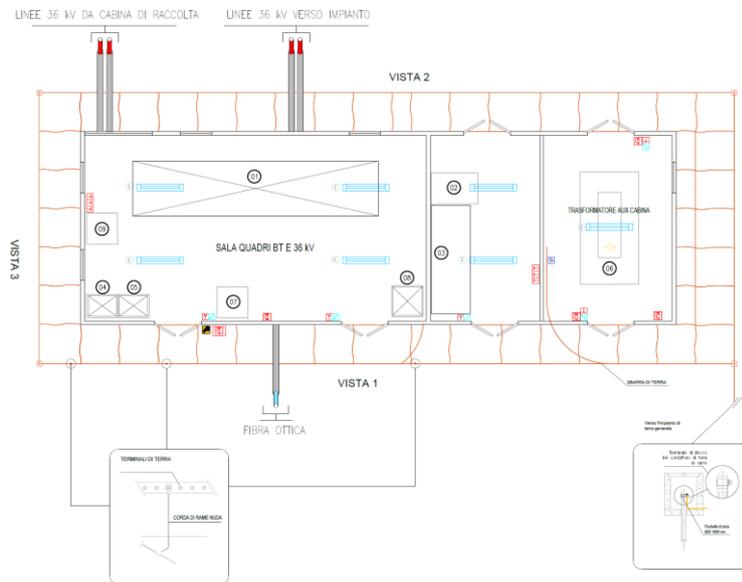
ALLESTIMENTO TIPO CABINA DI SEZIONAMENTO
